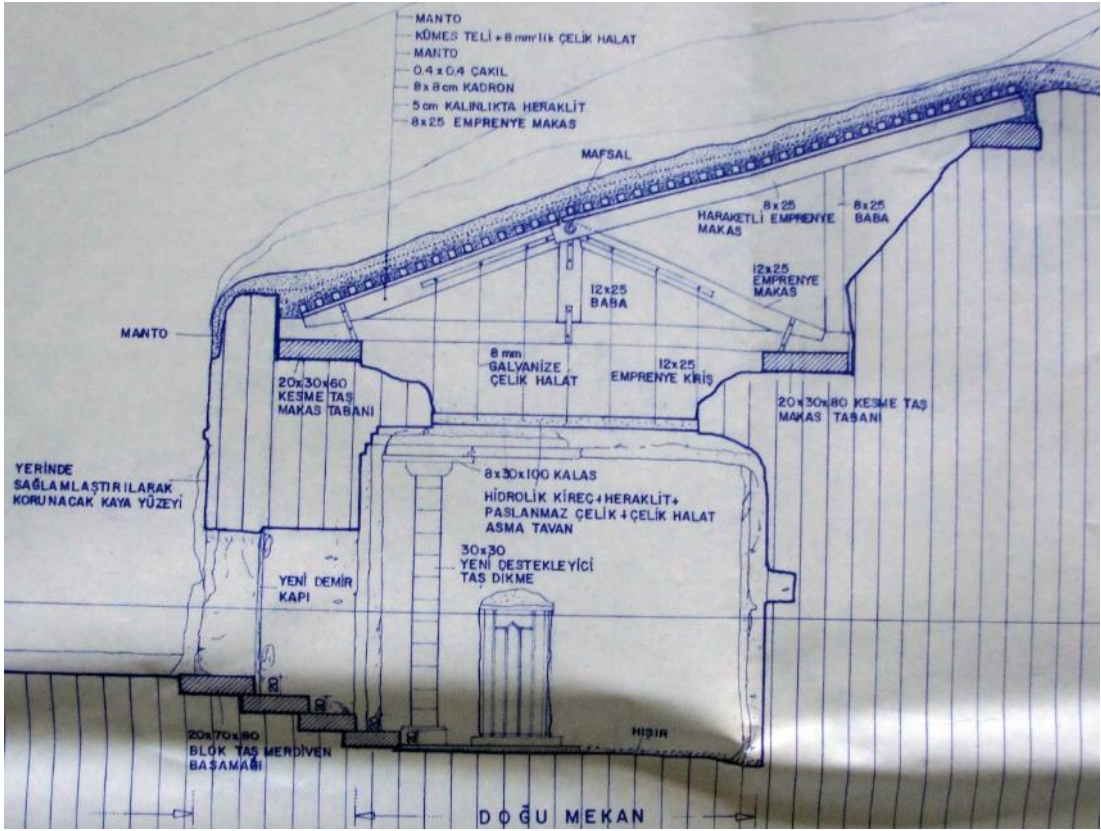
Sarica Kilise arazi planı ve müdahale tipleri (NKK Arşivi).
